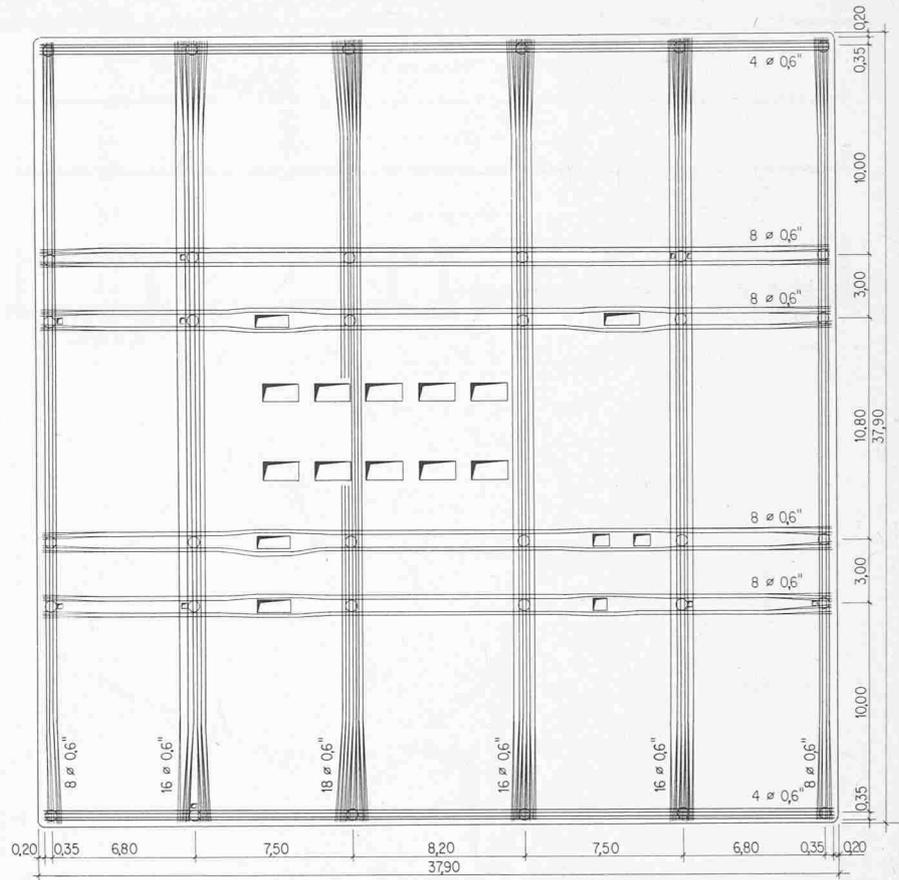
Mit Kleinspanngliedern ohne Verbund vorgespannte Flachdecke im Bildungszentrum Zofingen
